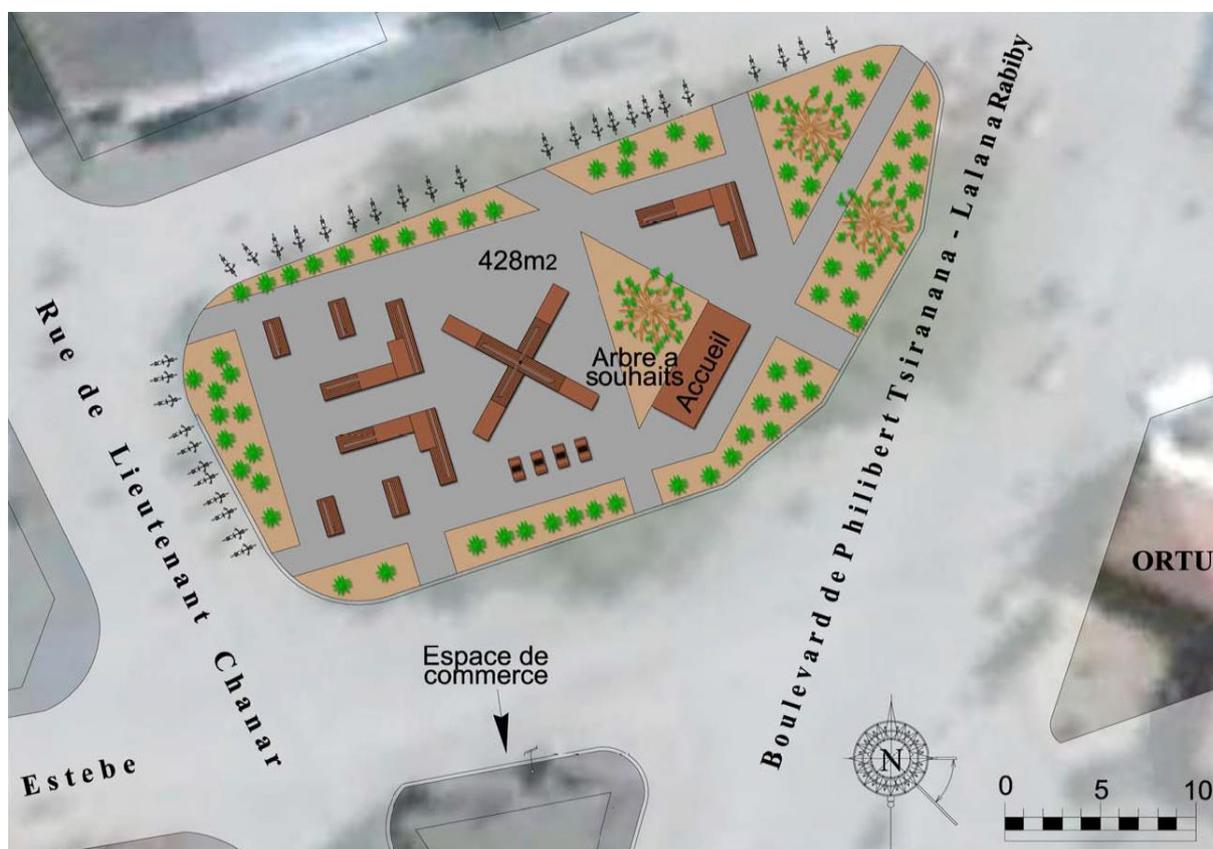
PLACE KILY SOAFILIRA - PLAN DE MASSE DES AMENAGEMENTS PROJETS
